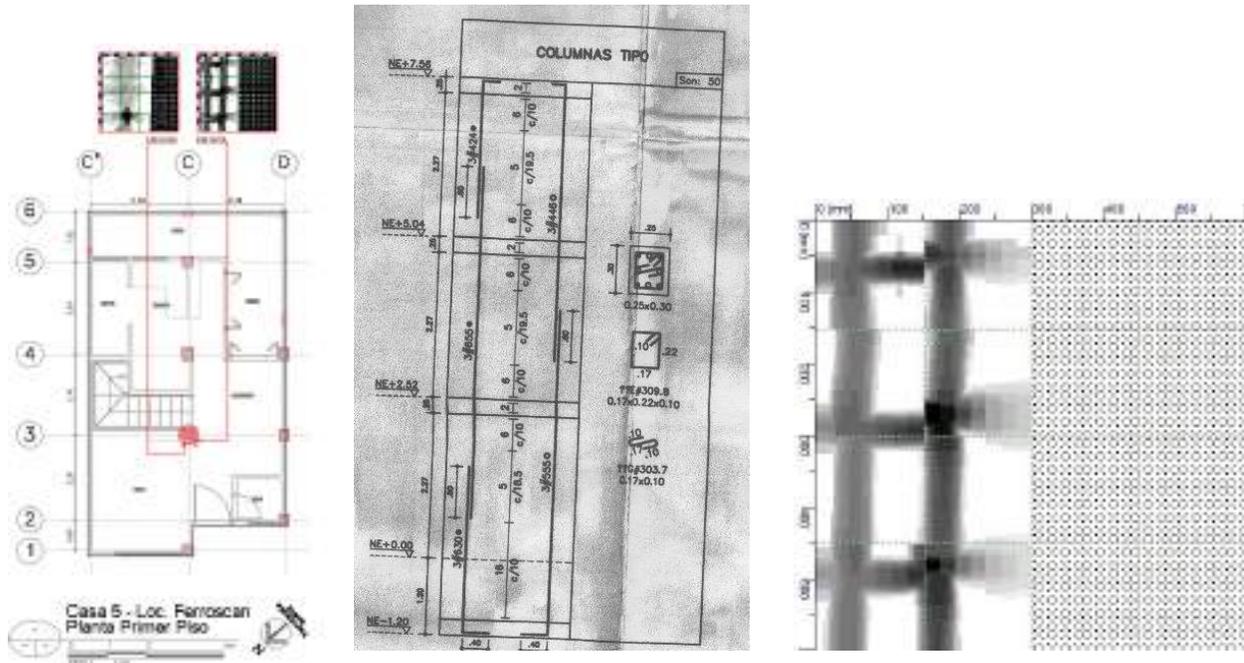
No se encuentra coincidencia en el despiece de la columna tipo, con menos refuerzo del que indica el diseño, con lo cual no se cumple con el reforzamiento diseñado y aprobado.
